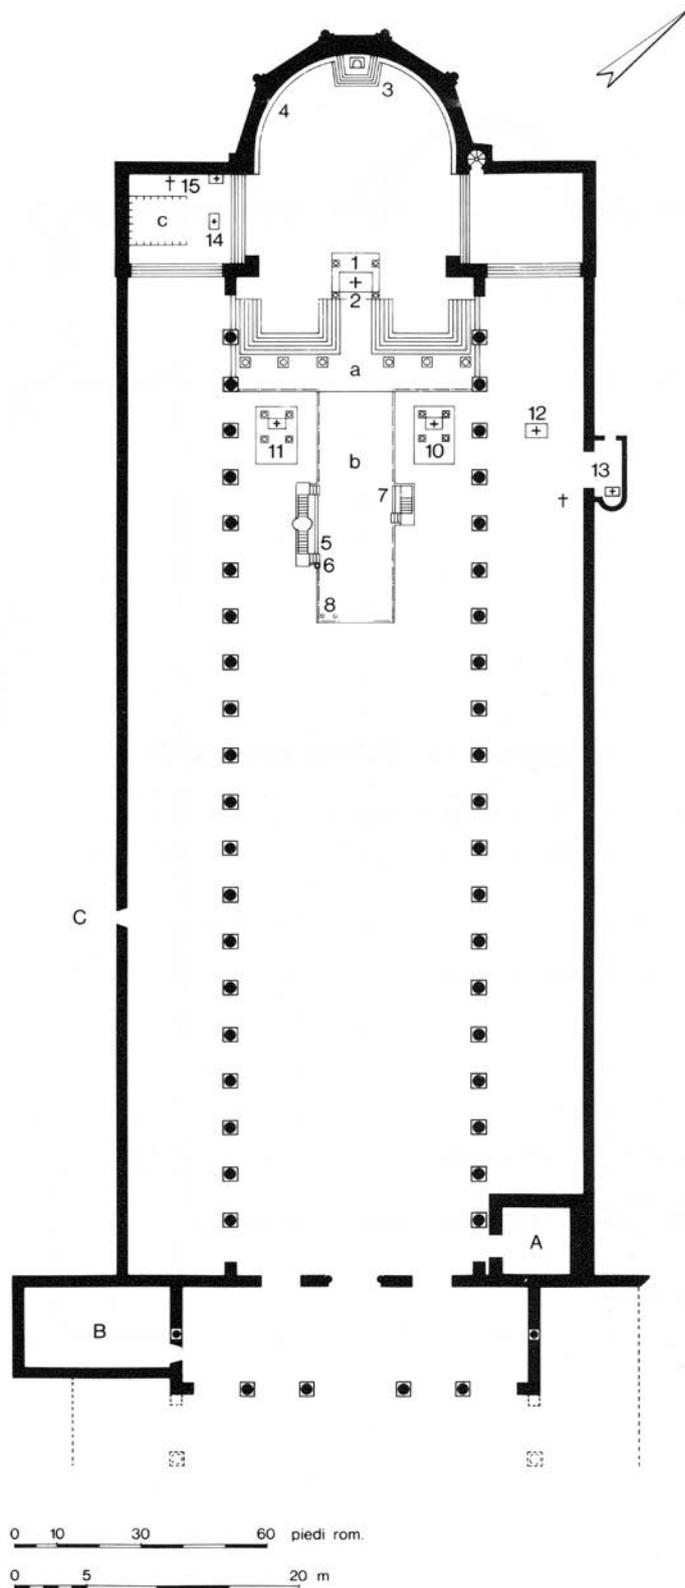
Rom, S. Maria Maggiore, Grundriss mit rekonstruierter liturgischer Ausstattung (nach De Blaauw 1994)
